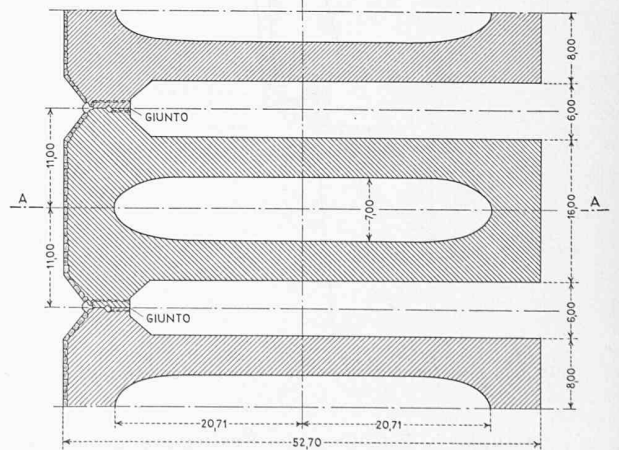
Staumauer Pantano d' Avio. Fugenabdichtung 1: 40
